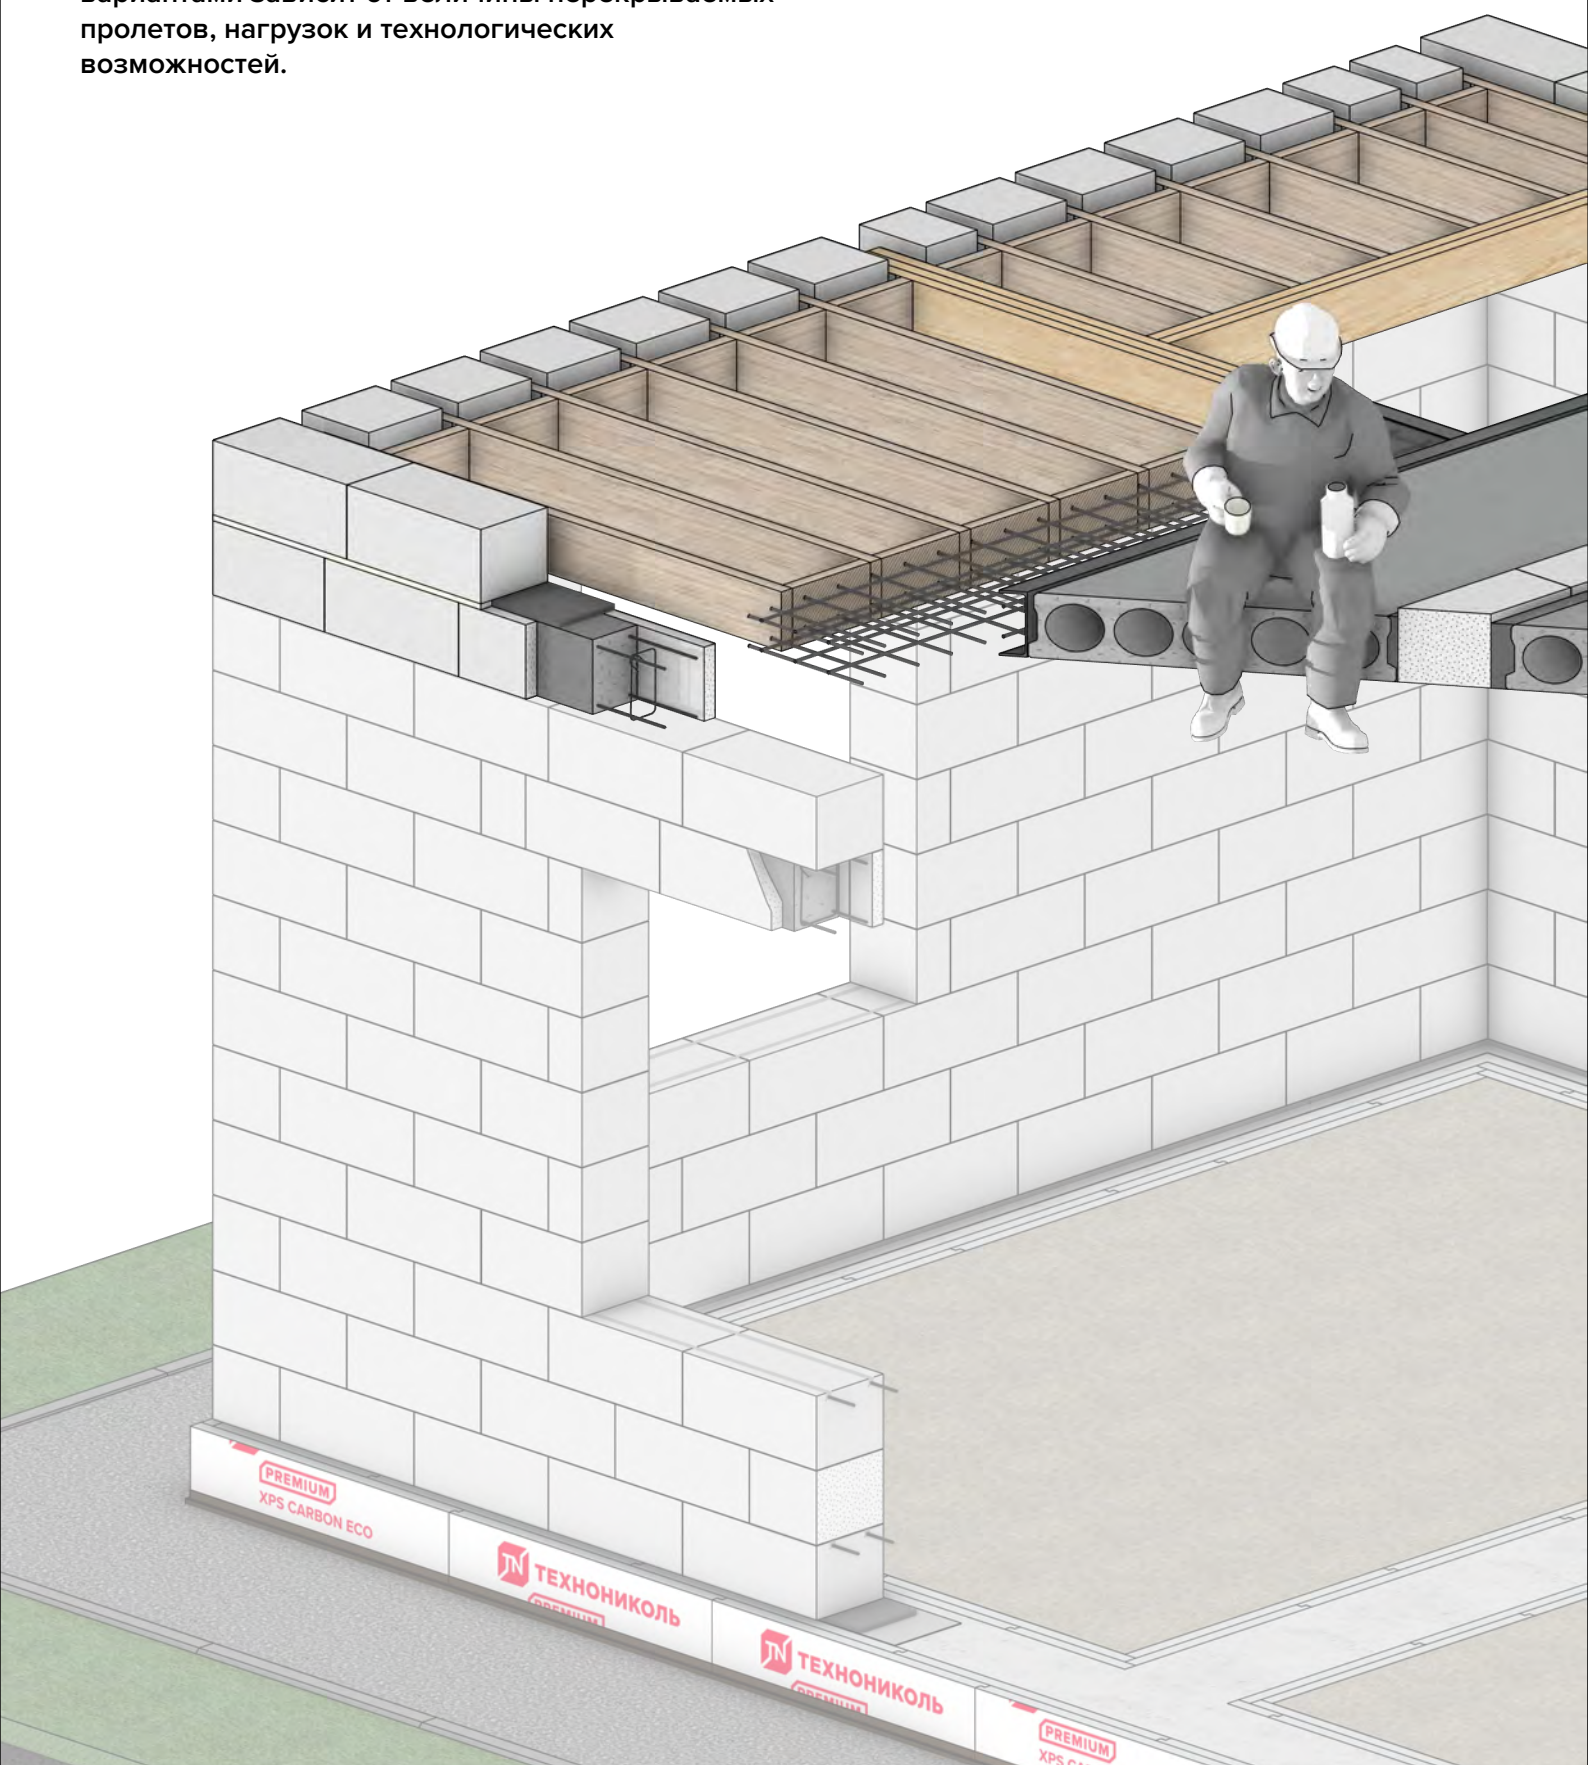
Железобетонный пояс малого сечения в небольшом доме
